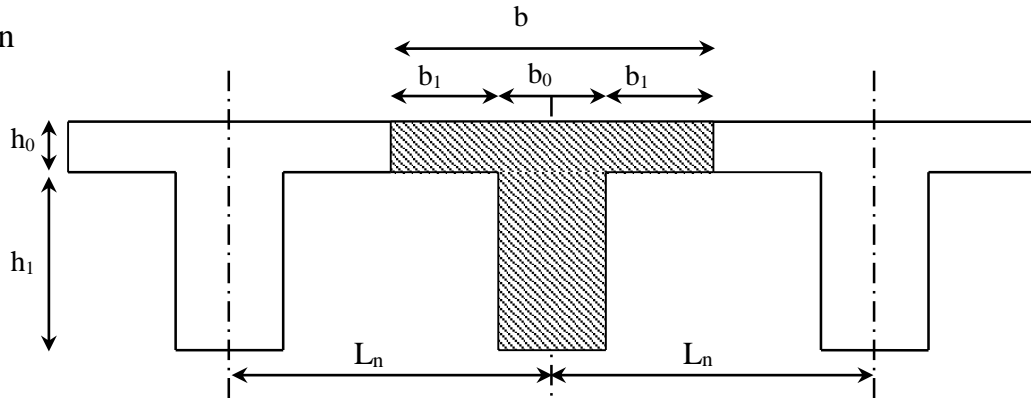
Coupe transversale d'un plancher à corps creux
